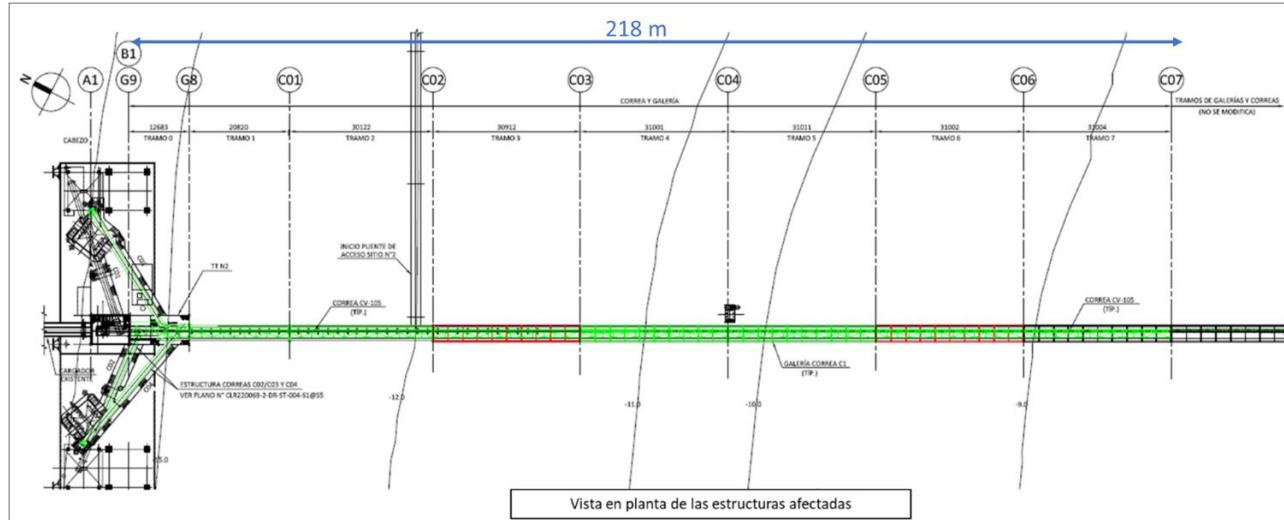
Vista en planta del viaducto de acceso y sitio 1.
